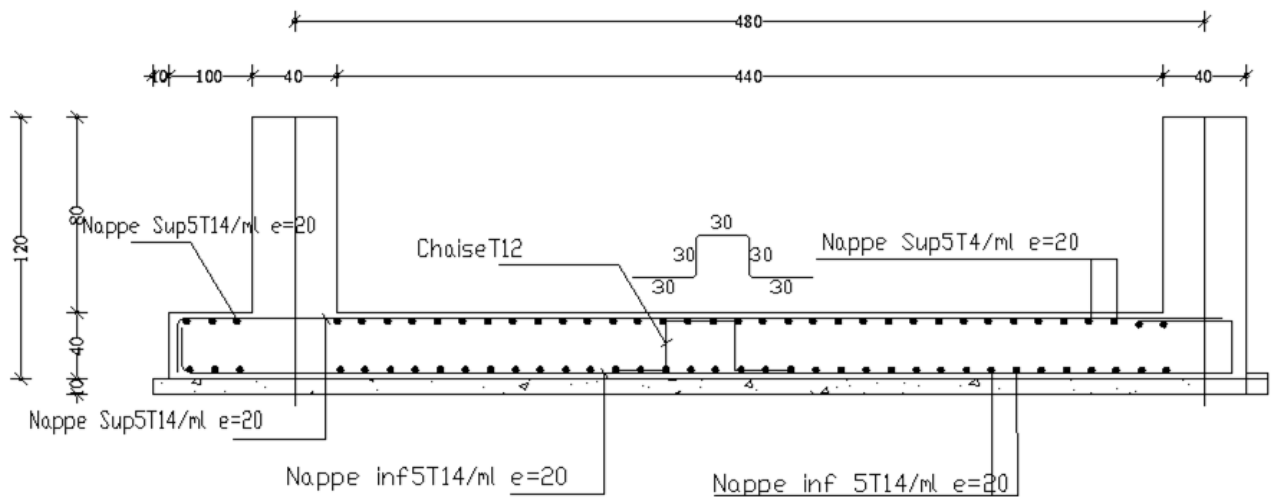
Dessin ferrailage de la dalle et le débord de radier
